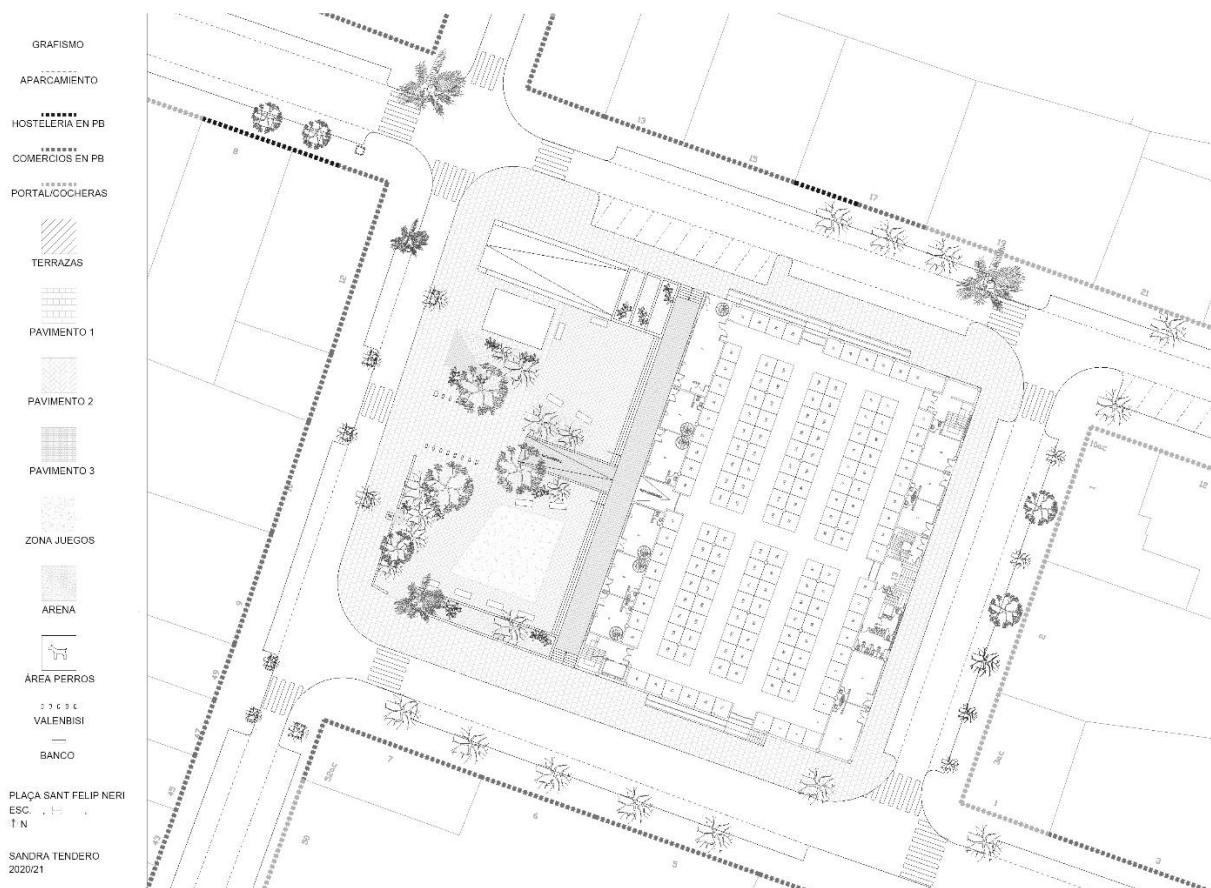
Plano Plaça de Sant Felip Neri. Elaboración propia.
